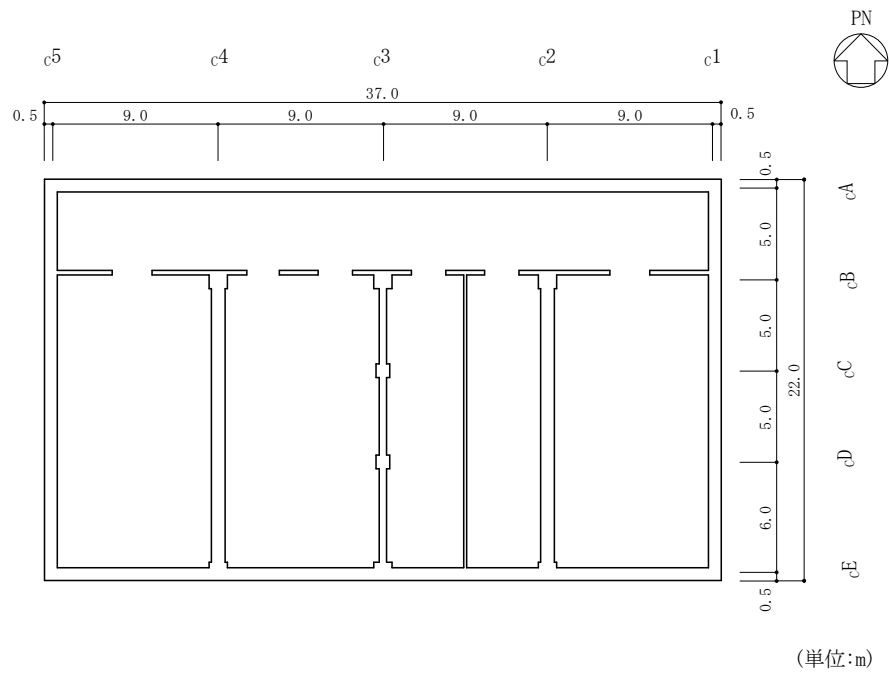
(1) 制御室建物の概略平面図 (EL 1.6m\*)
